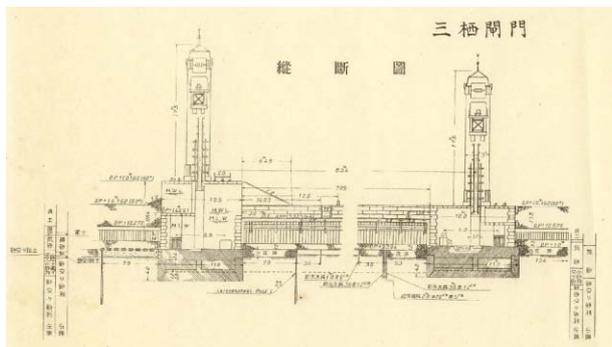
三栖開門立面図及び平面図（淀川資料館蔵）
